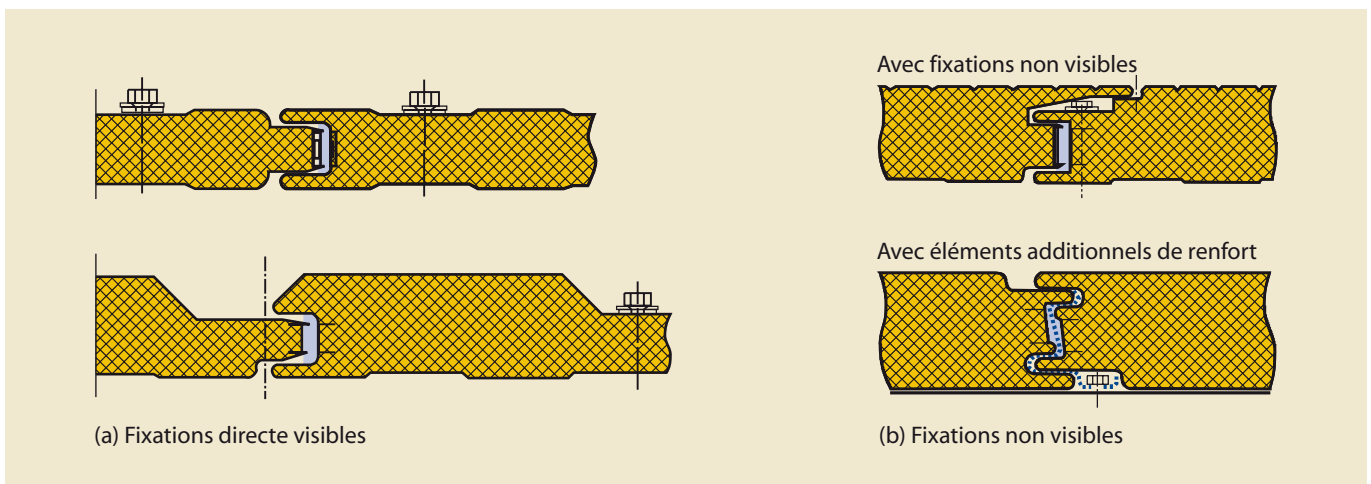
(Haut) Exemples de modes de fixation pour façades en panneaux-sandwich. Stahl-Informations-Zentrum : Dach und Fassadenelemente aus Stahl - Erfolgreich Planen und Konstruieren, Dokumentation 588, Düsseldorf, 2005
